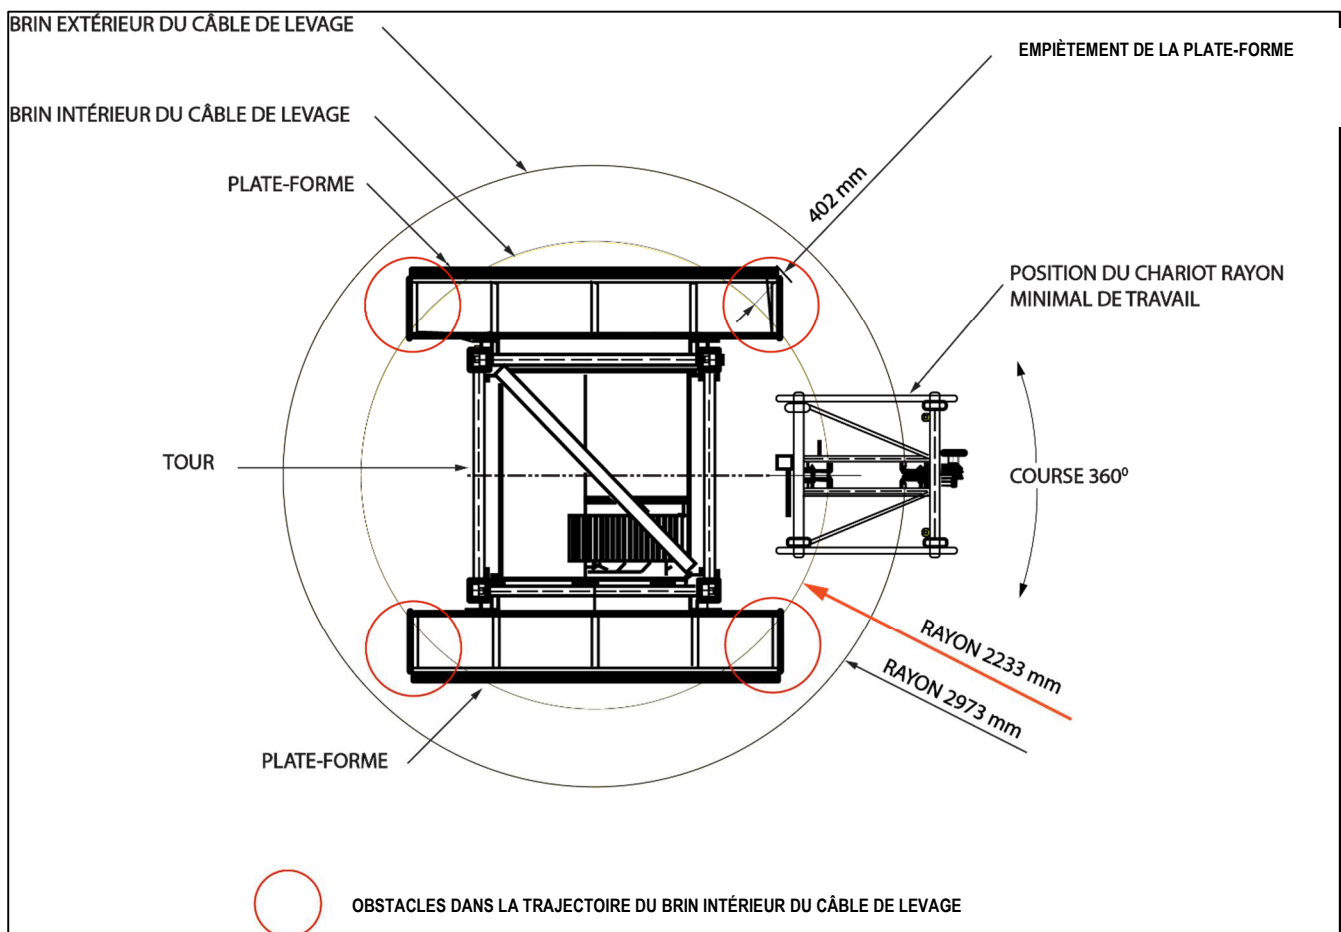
Obstacles dans la trajectoire du brin intérieur du câble de levage en position de rayon minimal de travail - vue en plan
